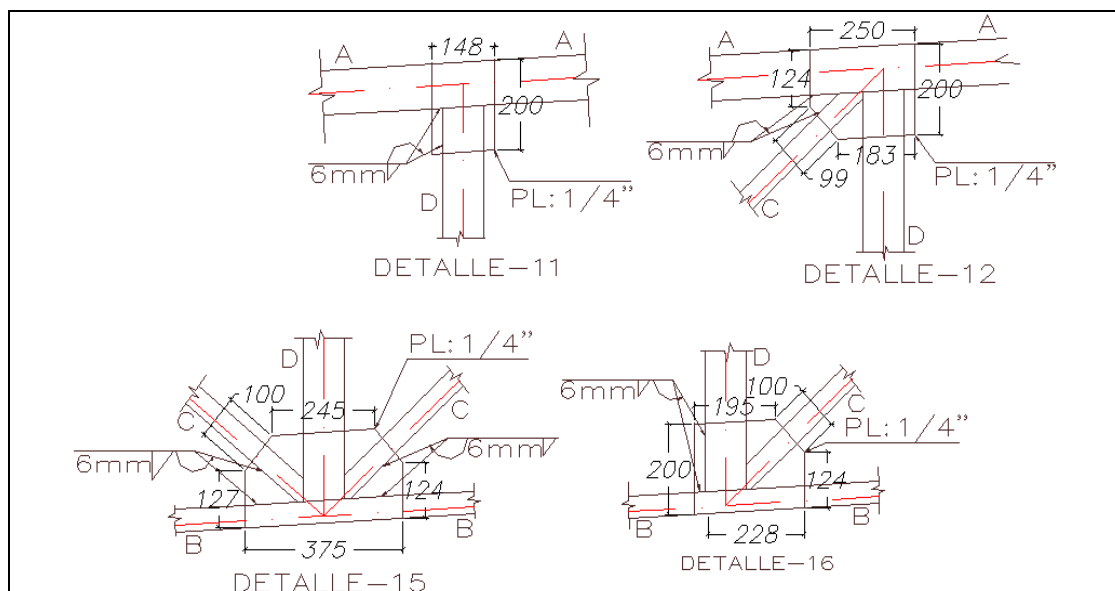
Detalles 11, 12, 15 y 16 de los nudos de las armaduras del proyecto definitivo del puente peatonal
